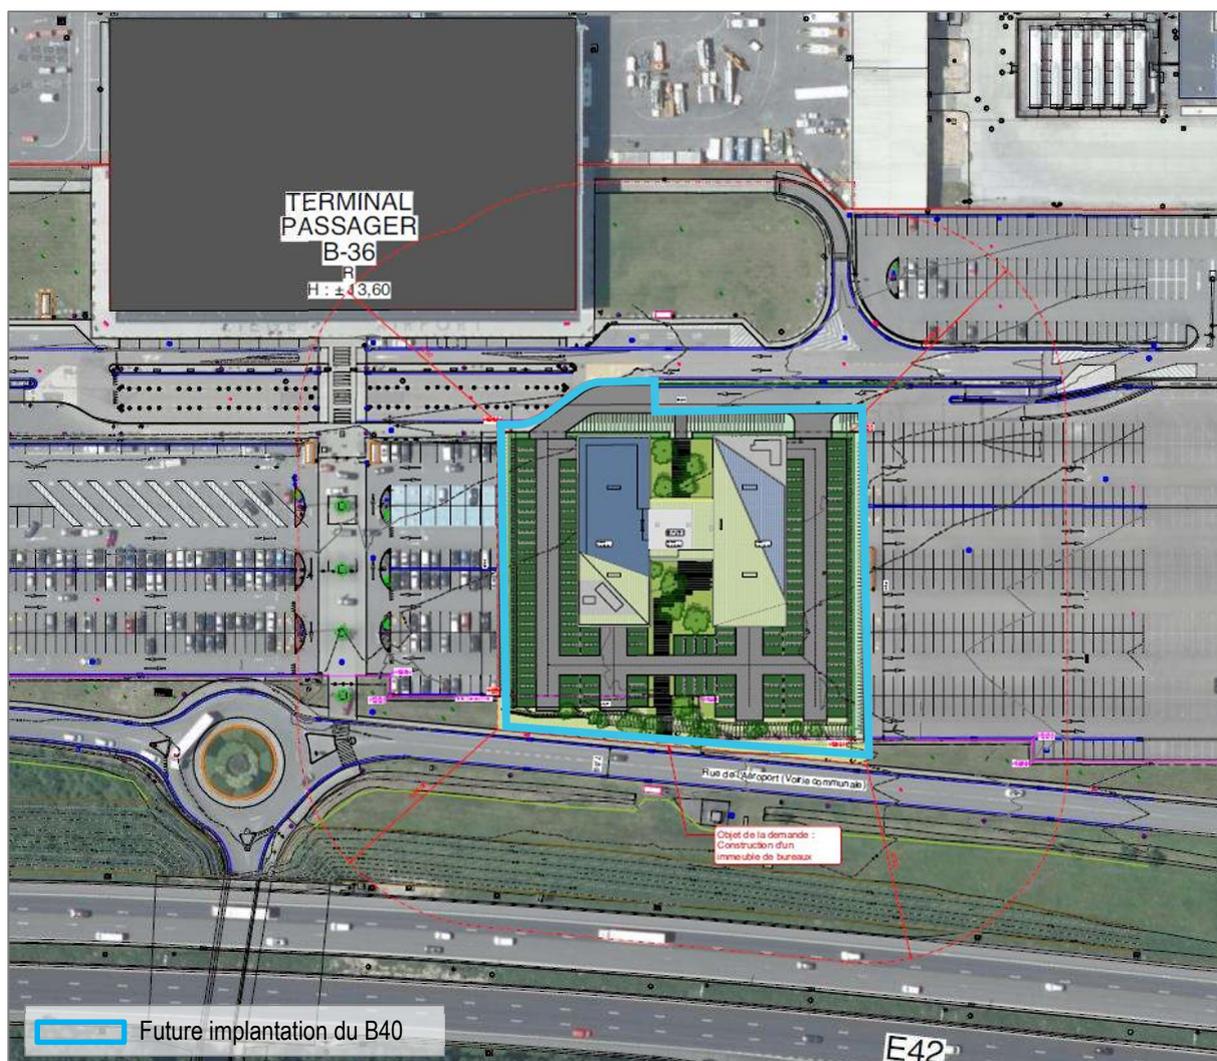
Plan d'implantation du bâtiment B40 (Valentiny Architectes, 2020)
